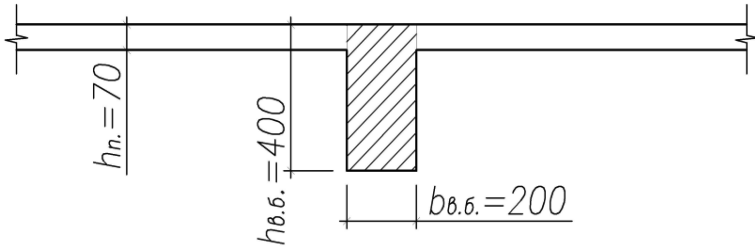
Расчетное сечение второстепенной балки при расчете на отрицательный изгибающий момент
